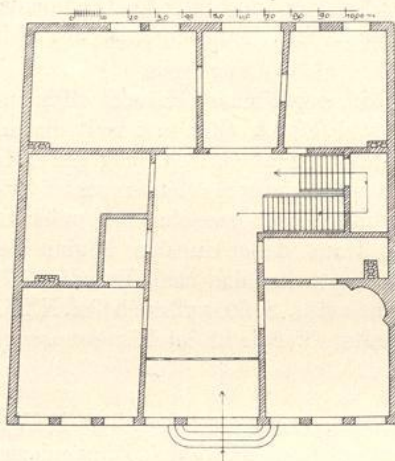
Marktstraße 6. Grundriß. Erdgeschoß.
